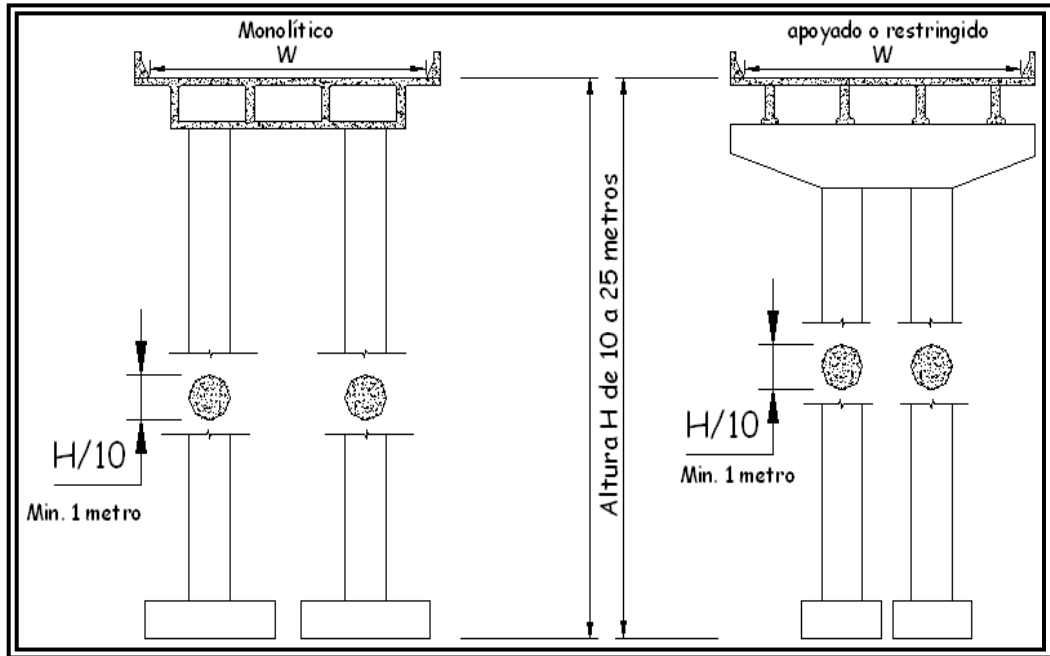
Pila de múltiples columnas de forma circular. ²⁶⁸
